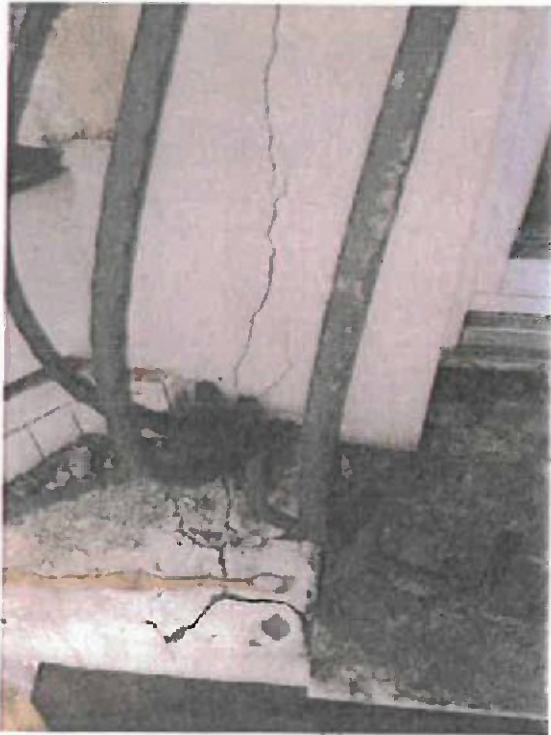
Korrodierte Geländerstäbe im Einspannbereich Mauerwerk und Rissbildung rechts
